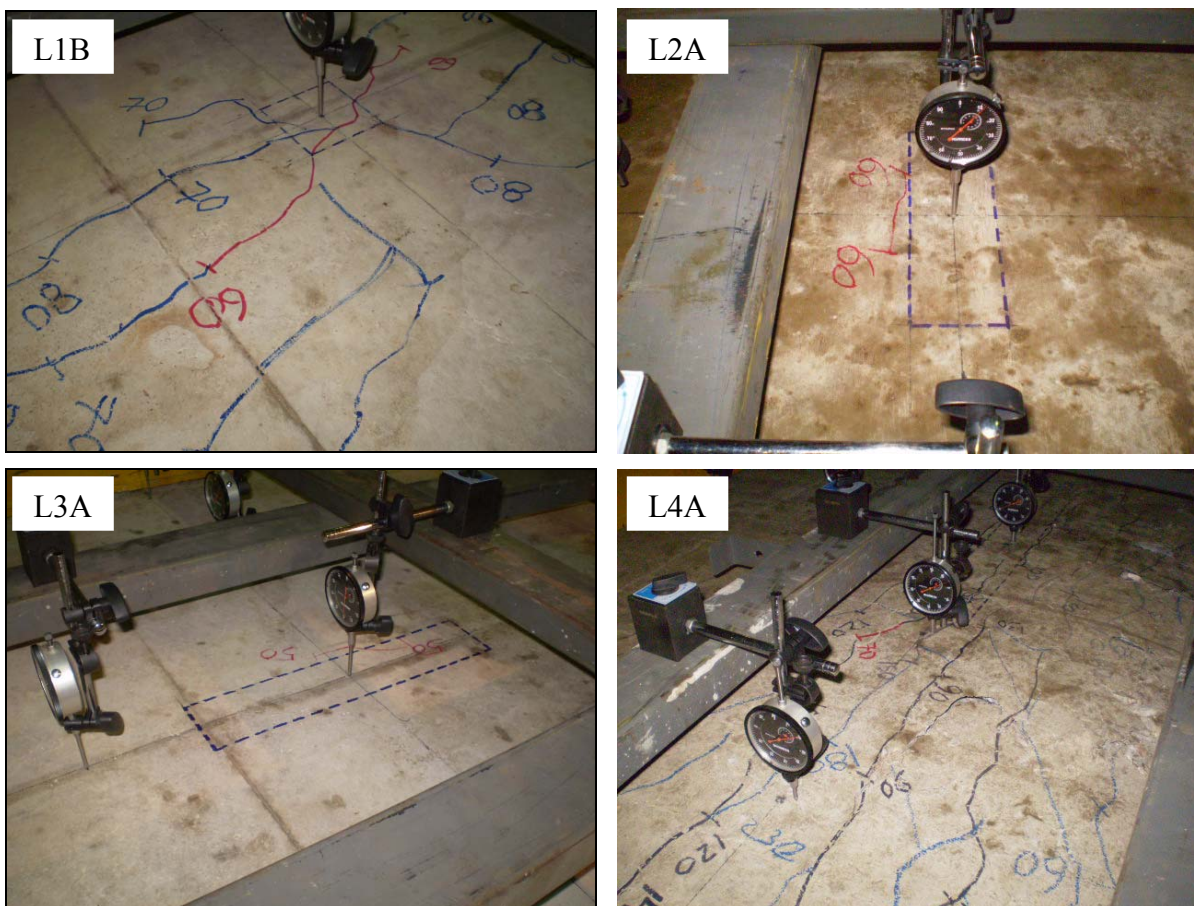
Marcação da primeira fissura das lajes L1B, L2A, L3A e L4A
